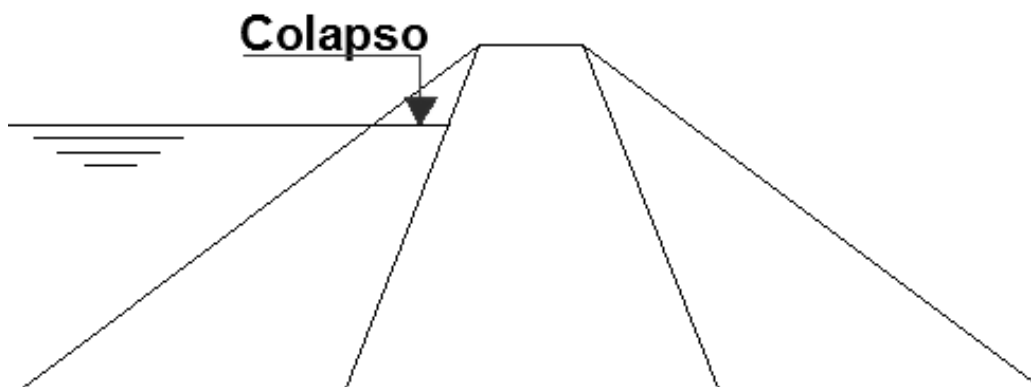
Colapso devido à saturação (Murrugarra, 1996).
